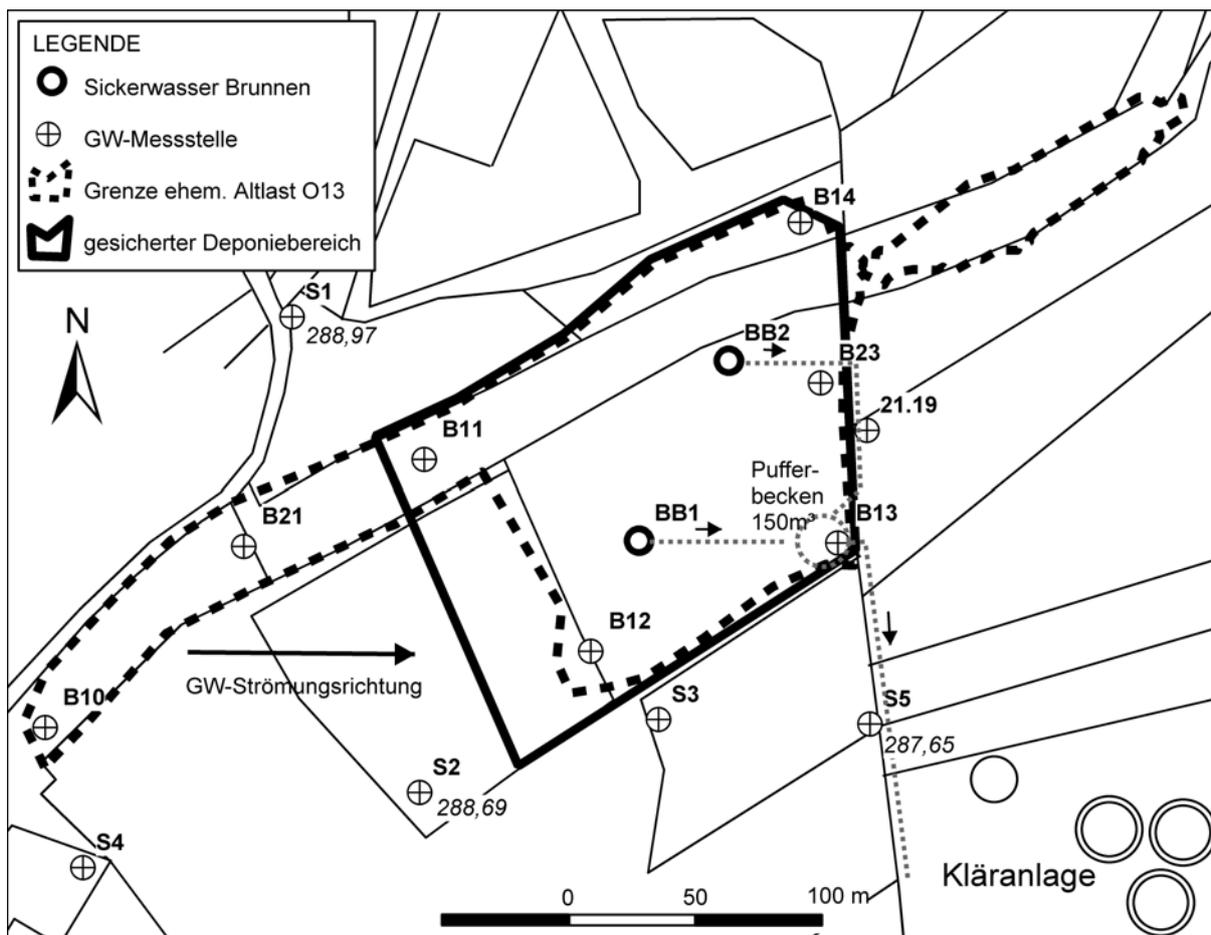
Detaillageplan Sicherungsmaßnahmen
